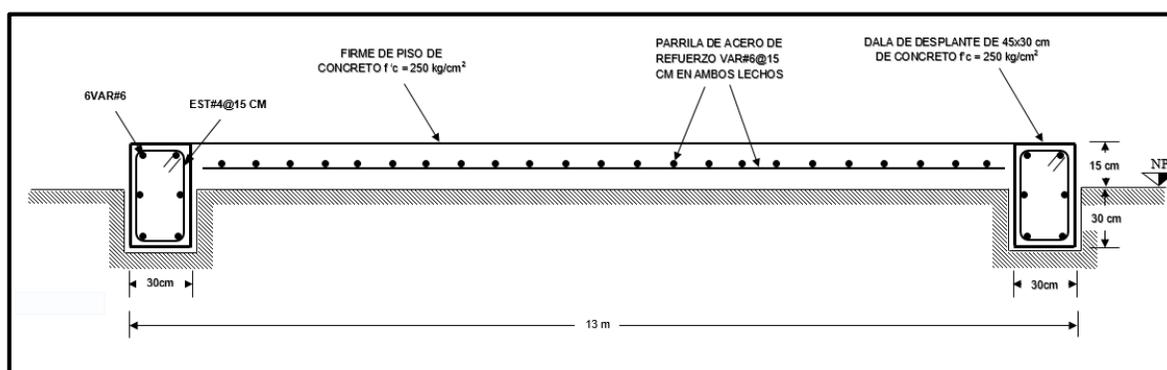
Detalle de dalas de desplante para Cimentación de la Ampliación de la Caseta
